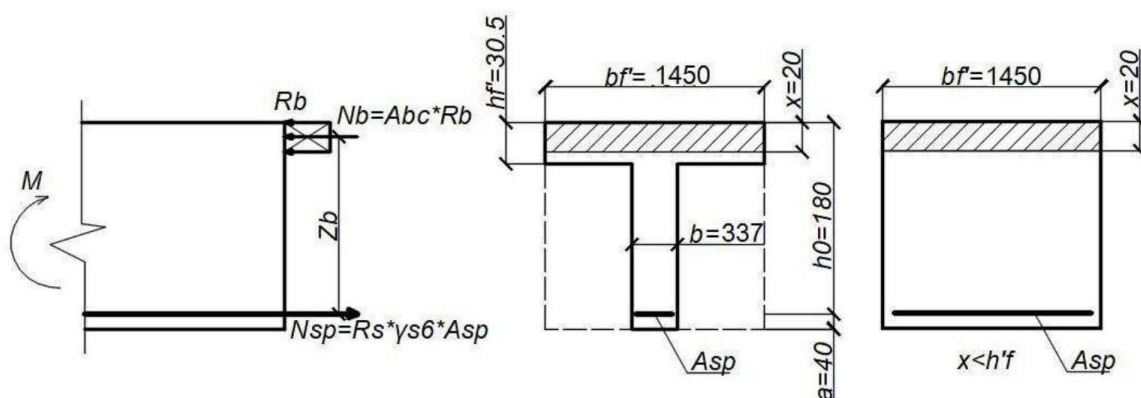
Схема внутрішніх зусиль попередньо напруженої плити
